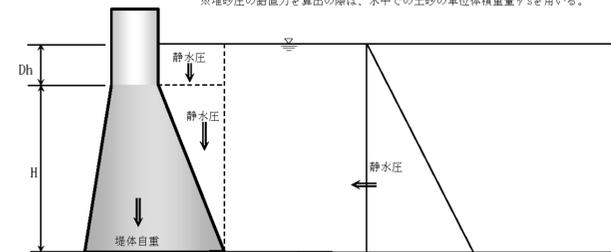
不透過型砂防えん堤 非越流部の設計外力図
